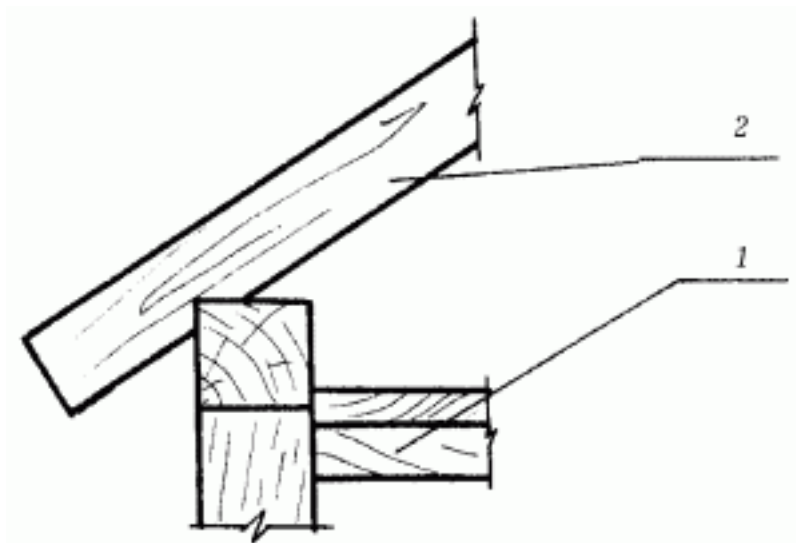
Опора наслонных стропил в деревянных каркасных домах: 1 – балка перекрытия; 2 – стропильная нога.
